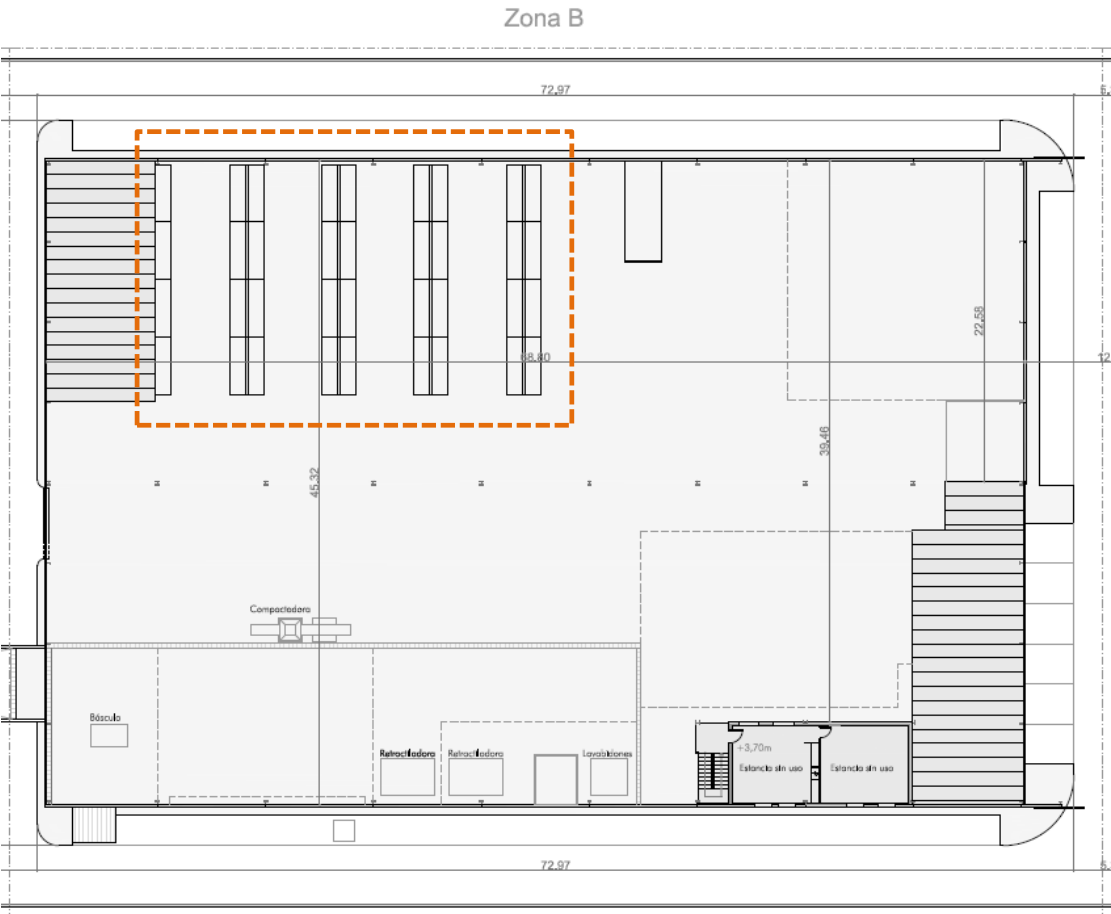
PLANTA ZONA DE ESTANTERÍAS
